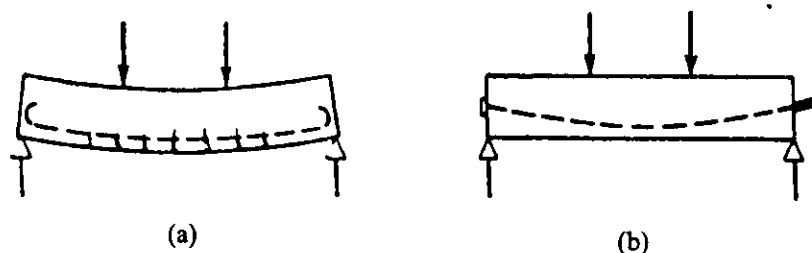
Deformación y agrietamiento en vigas: a) Concreto reforzado, b) concreto presforzado.
